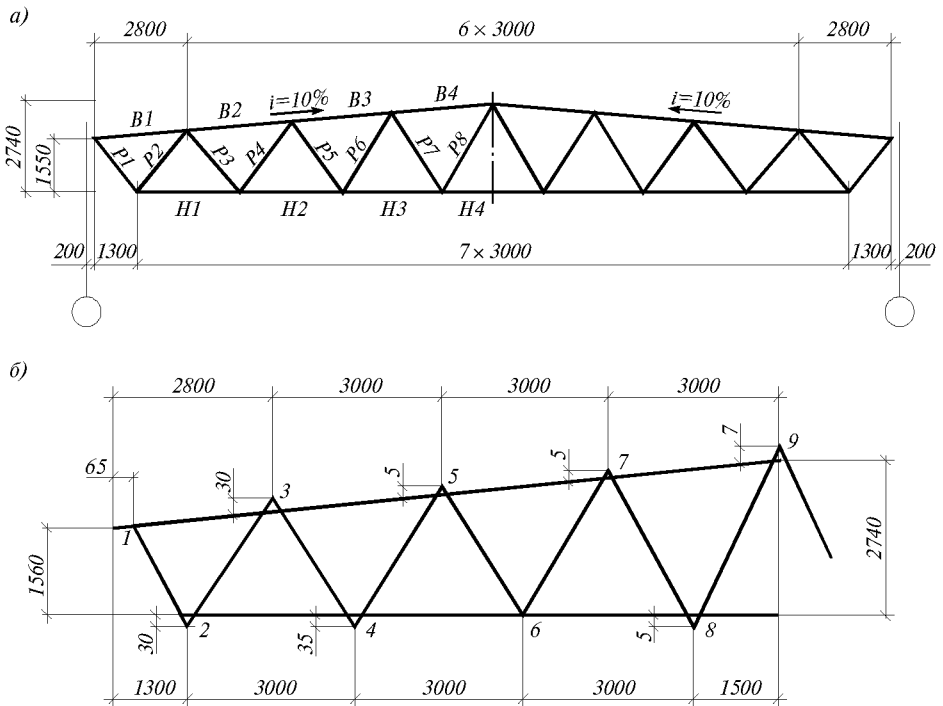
Расчетная схема стропильной фермы из гнутосварных профилей
